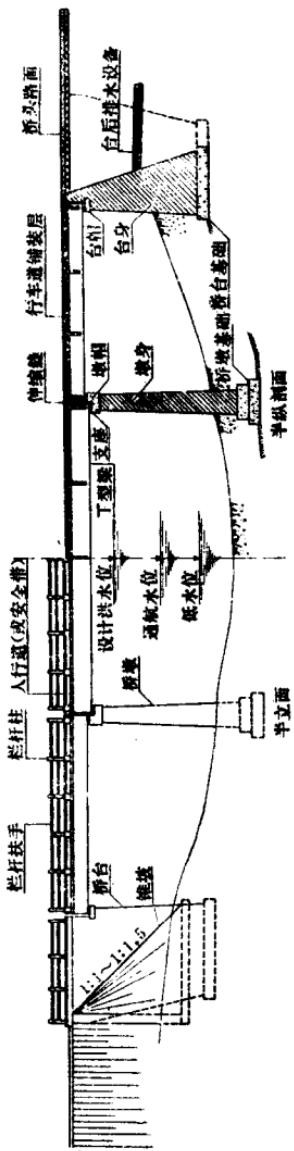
甲 装配式钢筋混凝土梁桥的一般构造(半立面、半纵剖面)
